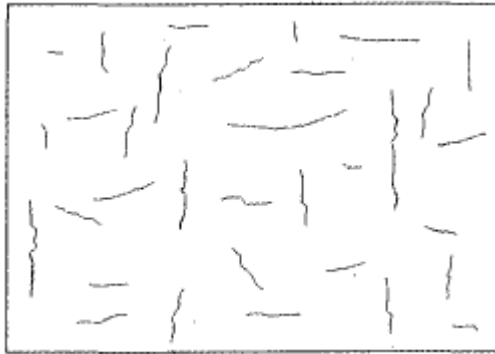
Columna fisurada por exceso de compresión.
